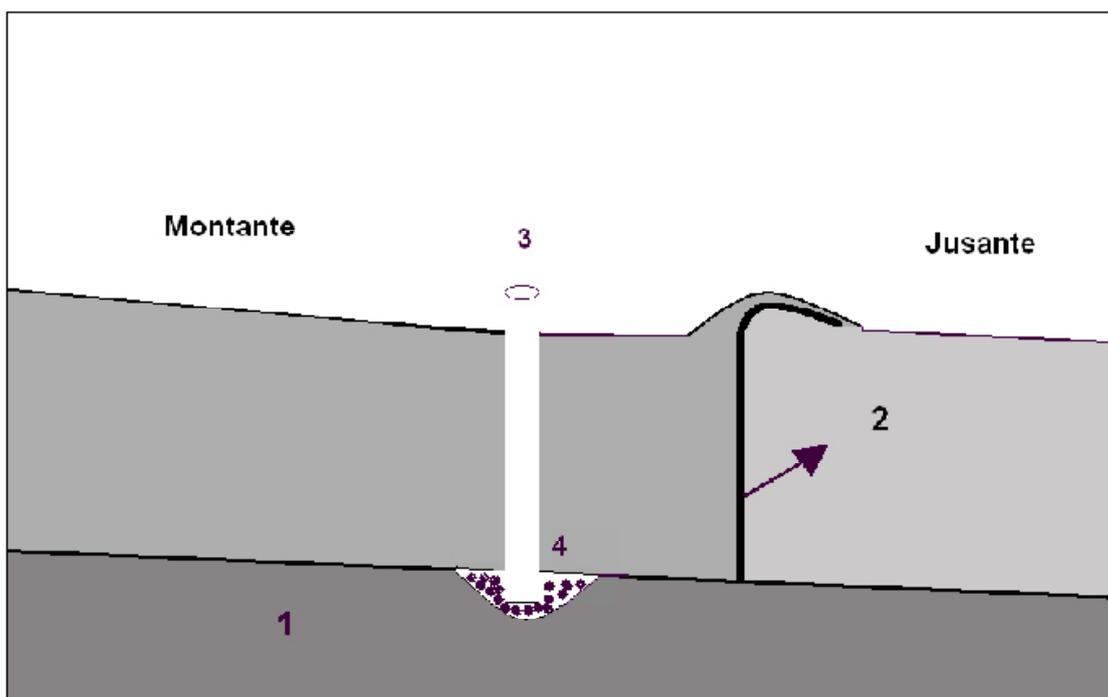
Corte transversal (1 = Camada impermeável; 2 = lona (manta) de polietileno; 3 = poço de manilhas ou tijolos; 4 = fundo do poço envolvido por cascalhos, pedras ou entulho limpo de obra).
